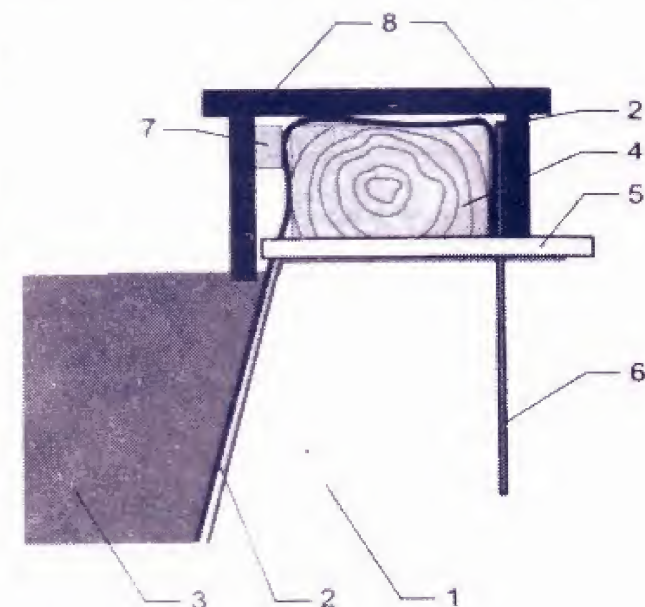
Схематичний розріз краю ставка: 1 - ґрунт; 2 - гідроізолююче покриття; 3 - вода; 4 - брус каркаса; 5 - переливна труба; 6 - металева смуга; 7 - брус; 8 - дошки.
